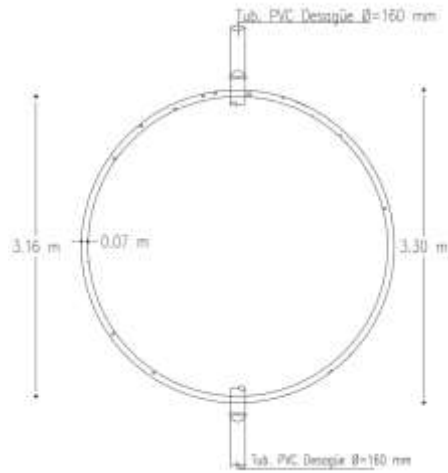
Vista en planta filtro Anaerobio de Flujo Ascendente
